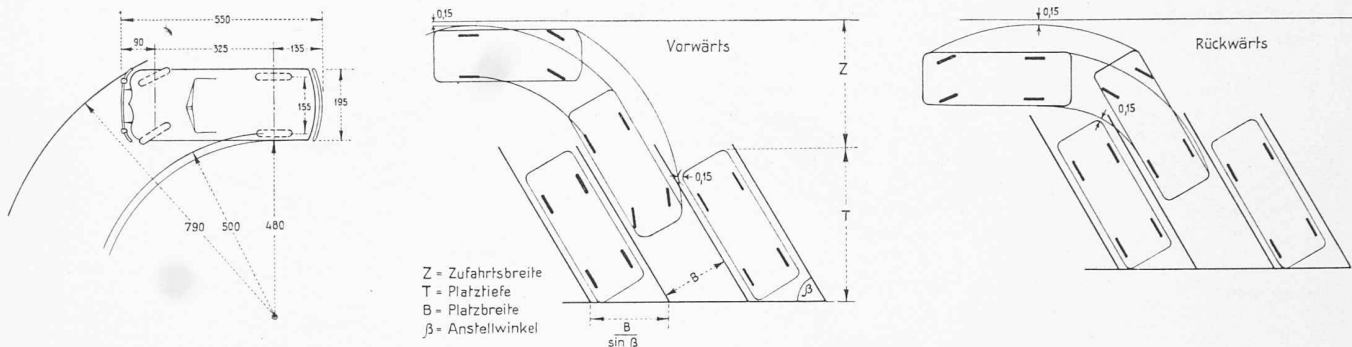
Fahrzeugausmasse (Grundlage für die Berechnung von minimalen Parkplatz- Dimensionen)
